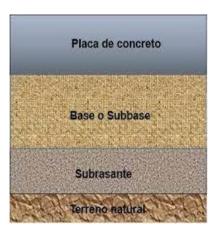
Estructura de un pavimento rígido tradicional.
